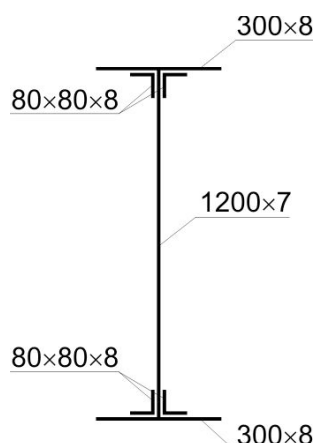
Dimensões (mm) da secção das vigas principais
